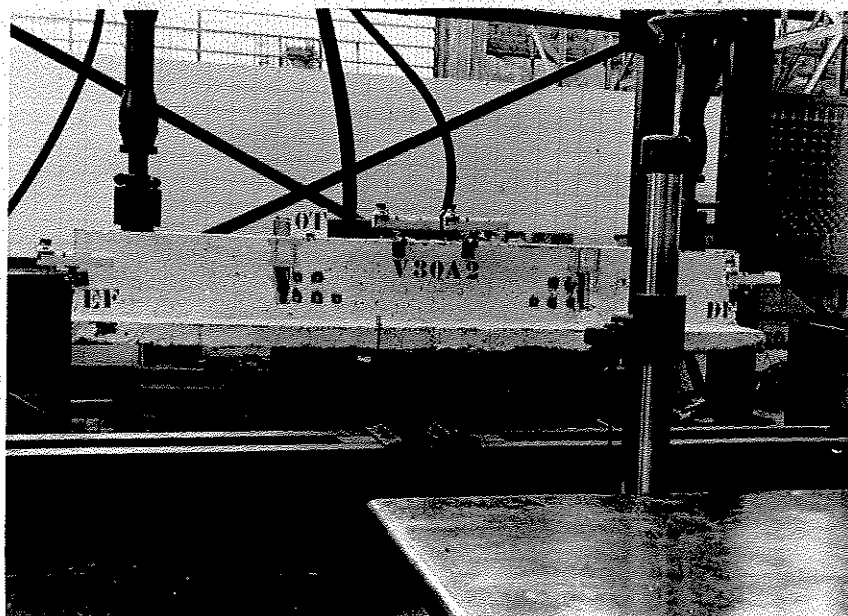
Vista geral do início do ensaio da viga V30A*.
